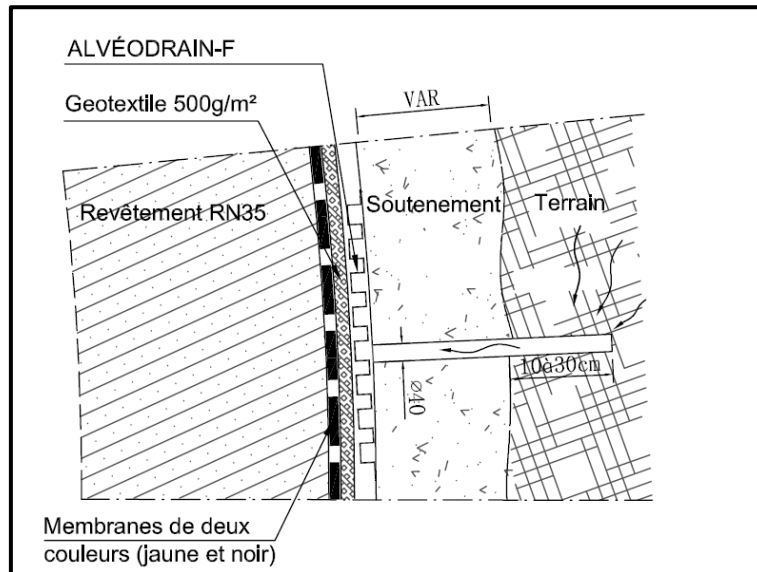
Détail du schéma du système d'assainissement « drainage et étanchéité ».
